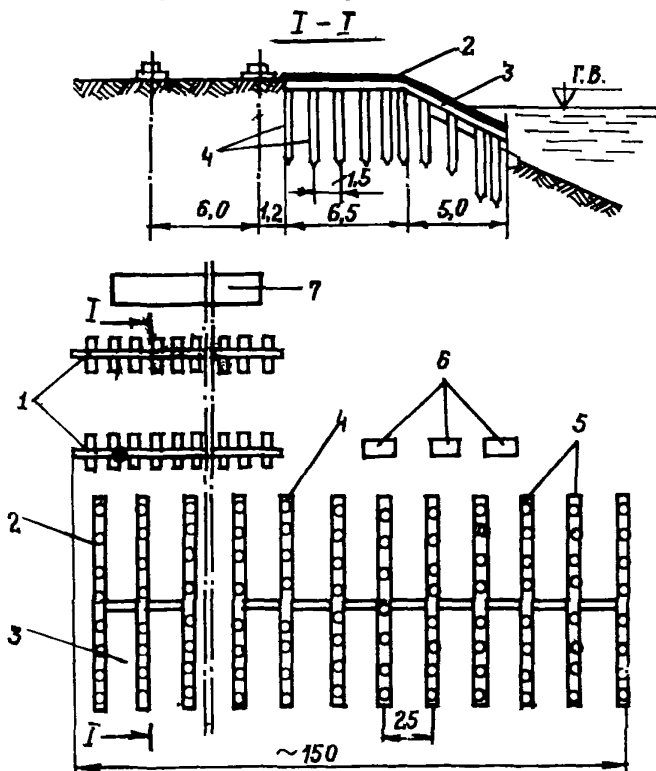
Схема ступенчатой площадки для монтажа трубопровода параллельно урезу воды:
